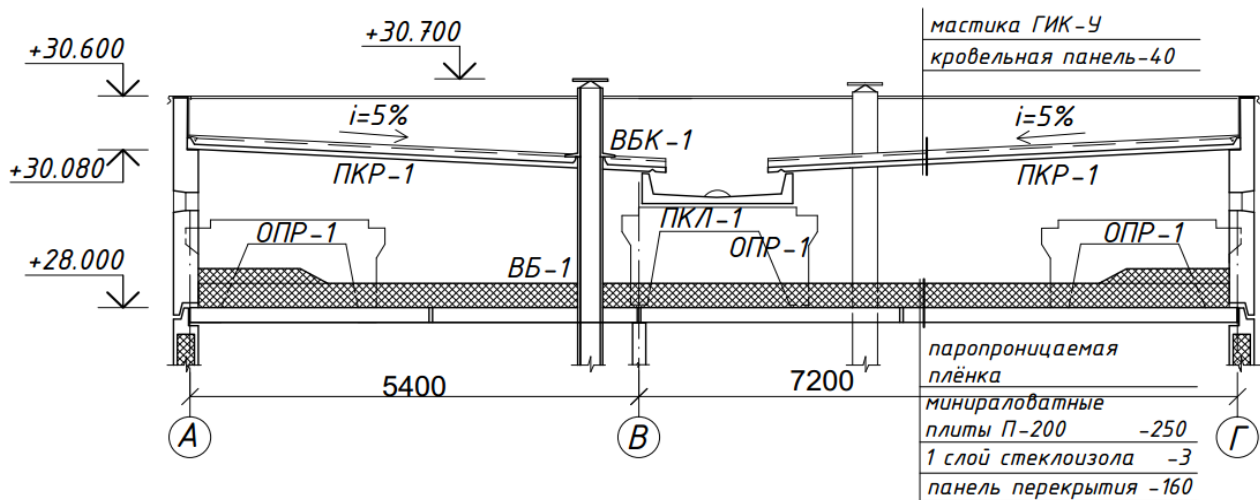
Холодный чердак и безрулонная кровля (поперечный разрез 1 : 1):
